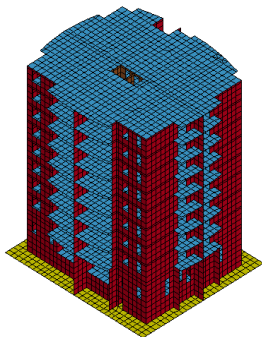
Расчетная схема исследуемого здания без сейсмоизоляции
